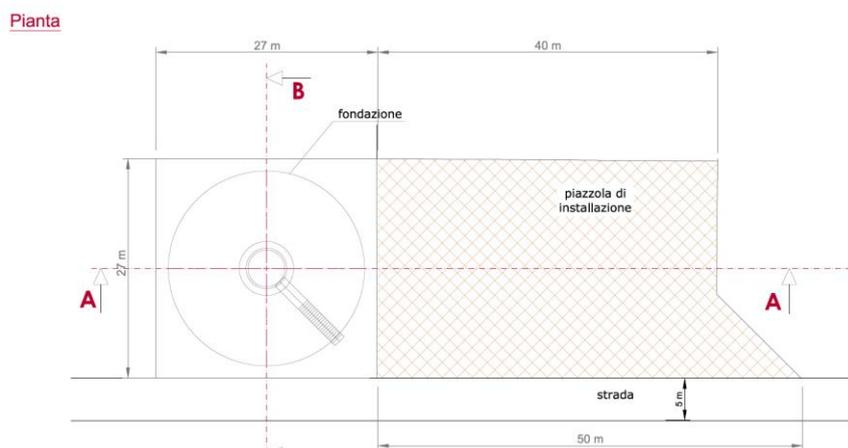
Piazzola definitiva tipo (pianta e sezioni)
